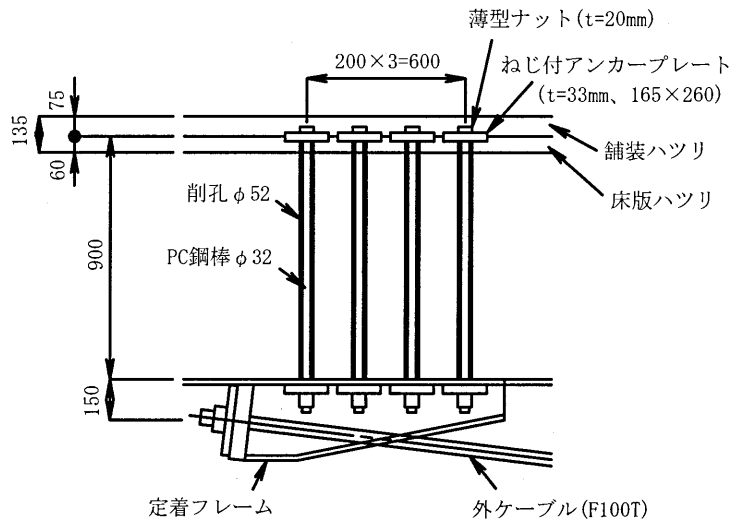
外ケーブルの定着構造(寸法単位: mm)
